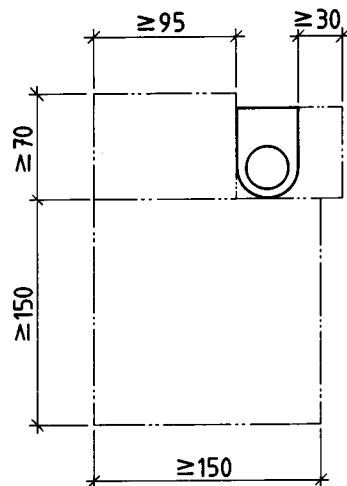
Bewegungsfläche vor und neben dem Klosettbecken
